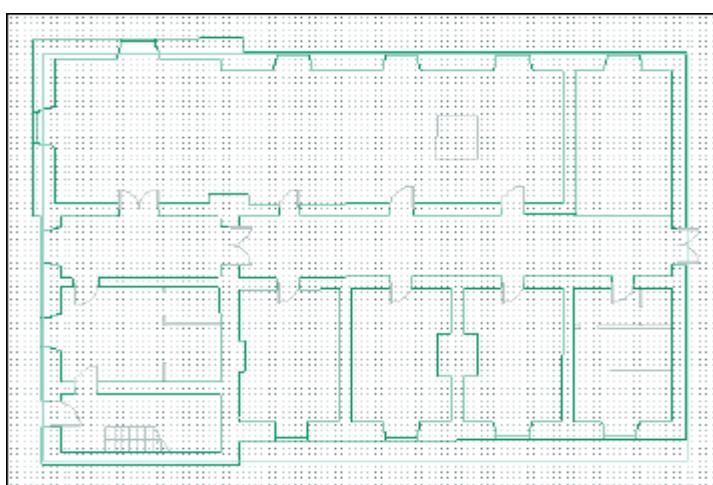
階の範囲を示すシアンボックスを表示したDXF平面図
